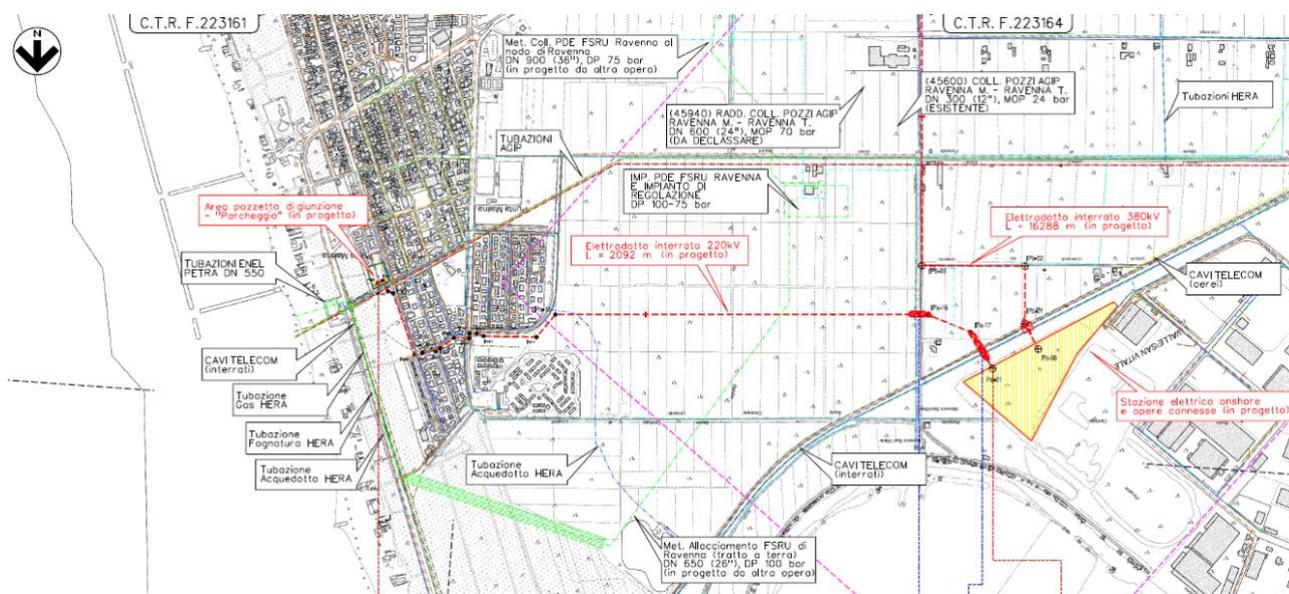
Planimetria generale del tracciato elettrodotta in cavo interrato 220kV
